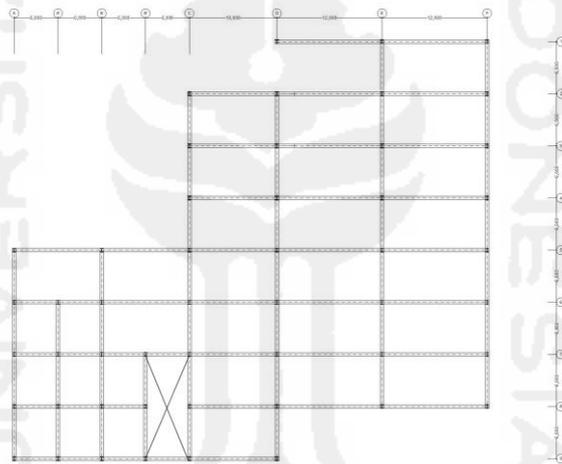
Skematik Struktur Lantai 1 Area Bahan Pangan
